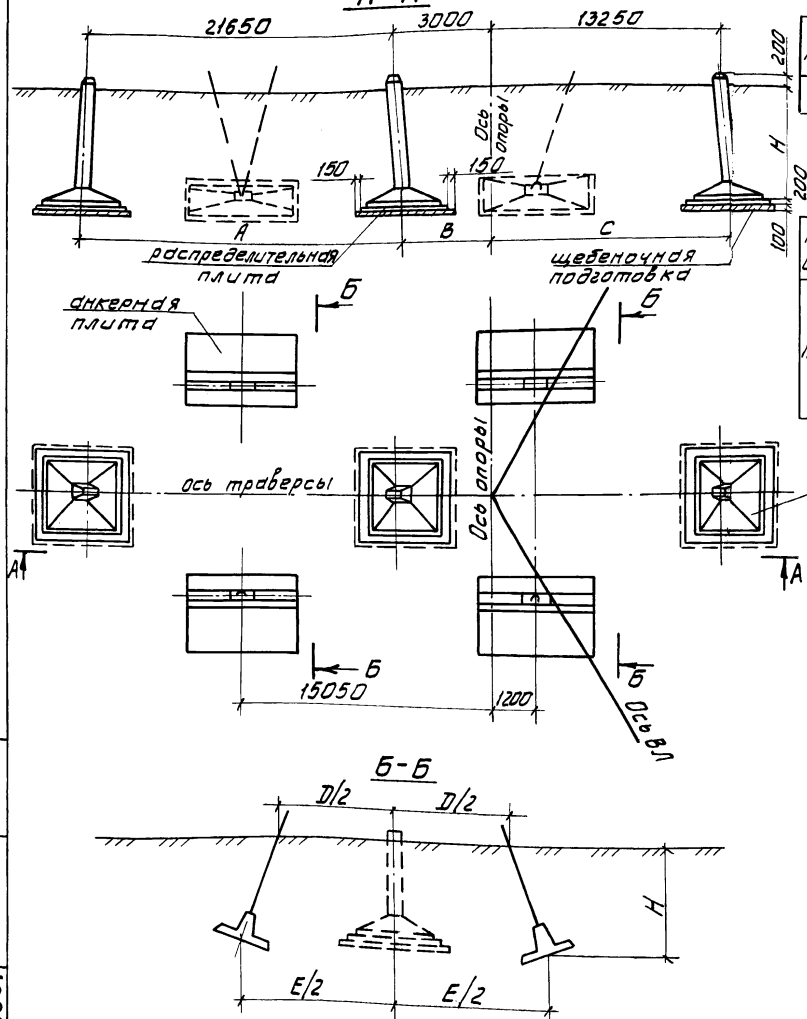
Схема фундаментов под промежуточно-угловую опору ПЧБ-20
